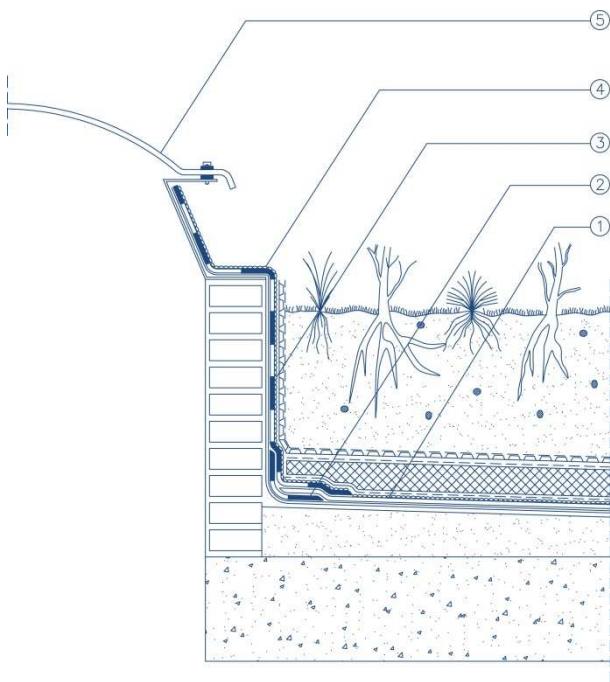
Encuentro con claraboya impermeabilización bituminosa
